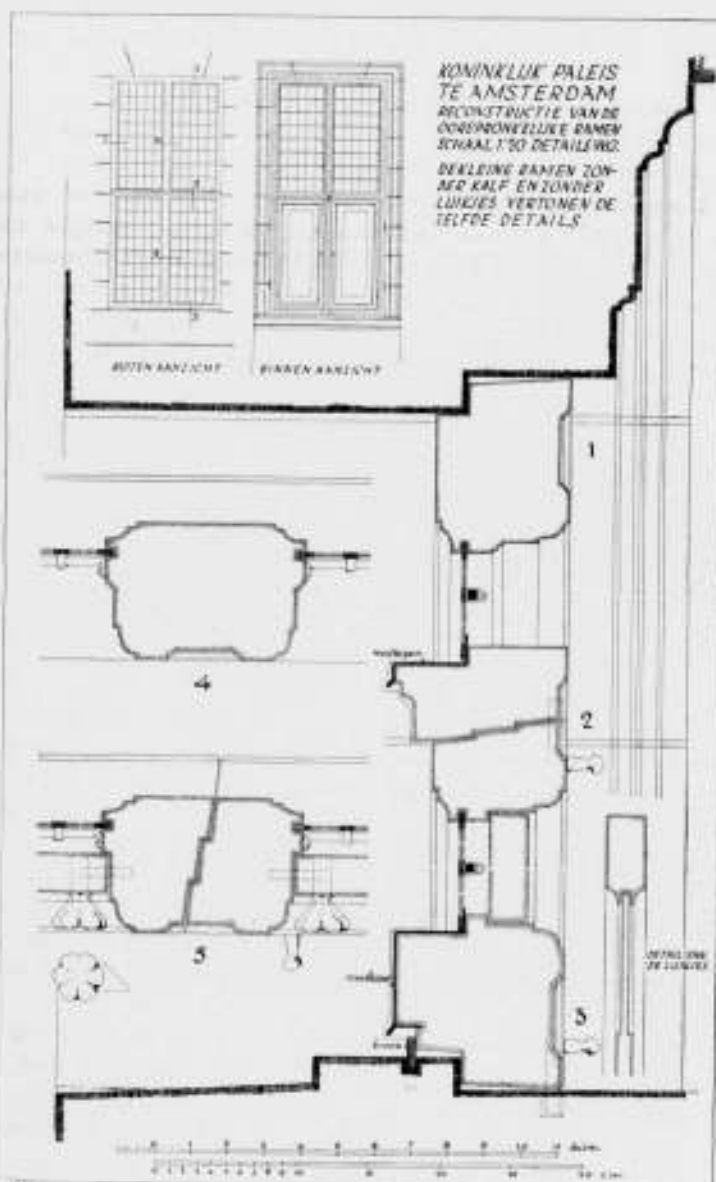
RECONSTRUCTIE VAN DE OORSPRONKELIJKE RAMEN. DETAILS SCHAAL 1 A 5.
